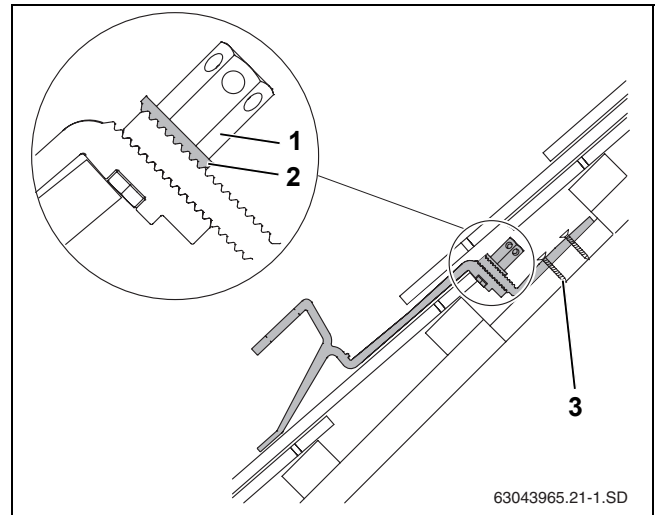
Gancho de tejado montado – vista de la sección con parte inferior del gancho de tejado acortada
